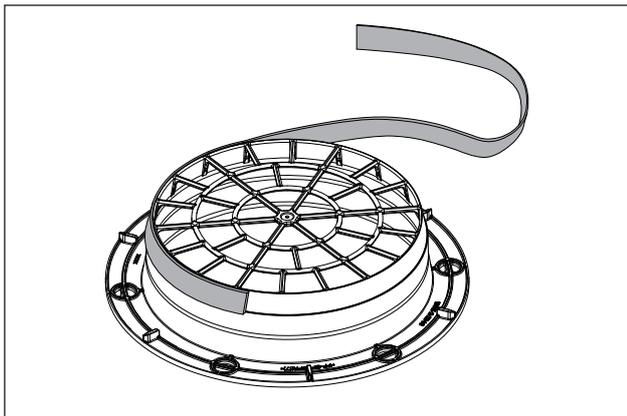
Posición de la cinta selladora para el montaje con tubo redondo
